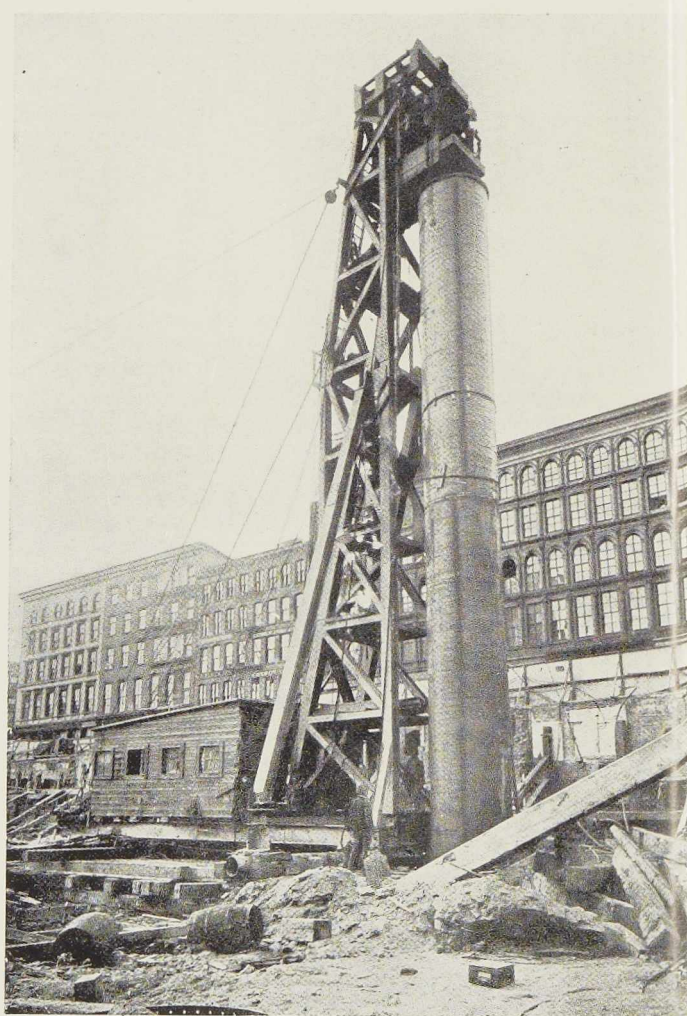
Fonçage d'un caisson tubulaire des fondations du Bâtiment Fédéral à New-York.
